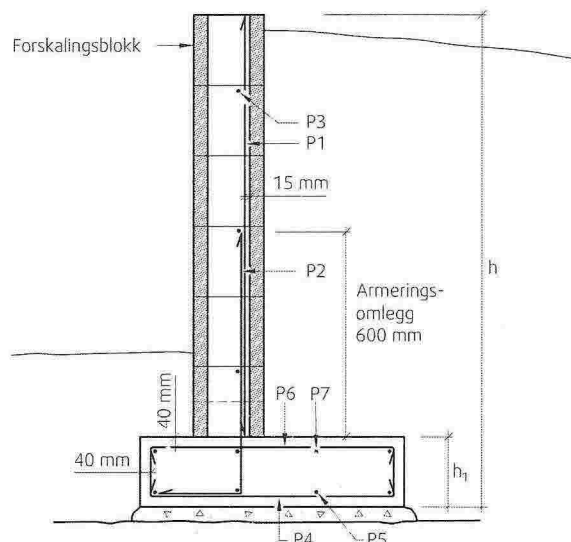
Plassering av betongarmering i utstøpt støttemur av Forskalingsblokk.
